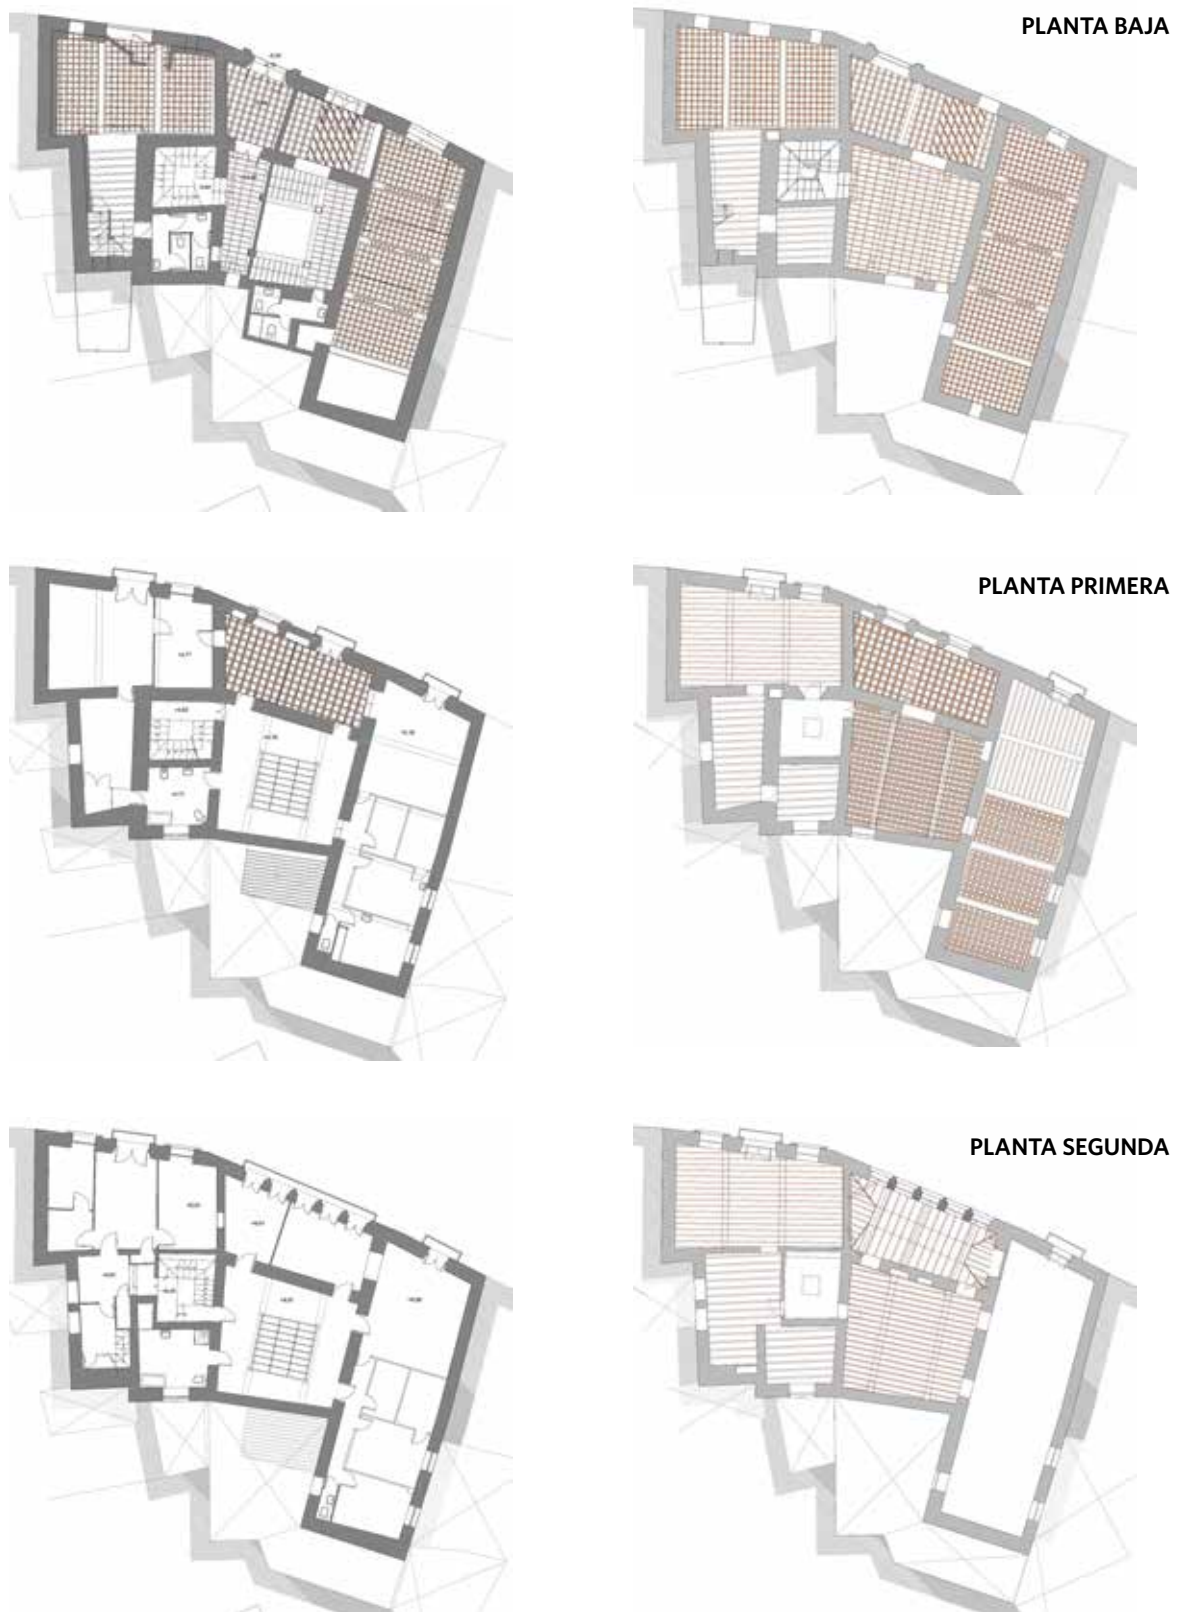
Planimetría comparada de las tres plantas del edificio. A la izquierda, estado previo en el que aparecen las armaduras que entonces se conocían. A la derecha, estado tras las obras, donde se indican todas las estructuras de madera que ahora tiene la casa: tres armaduras de cubierta y quince alfarjes. También se grafía el ascensor, de pequeñas dimensiones, que se ha instalado en el ojo de la escalera, de forma que el edificio sea accesible a personas con movilidad reducida.
